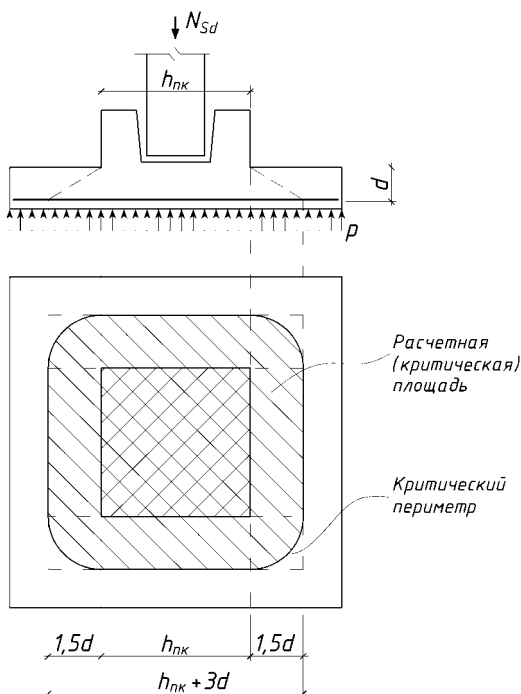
Расчетная схема фундамента при проверке на продавливание
